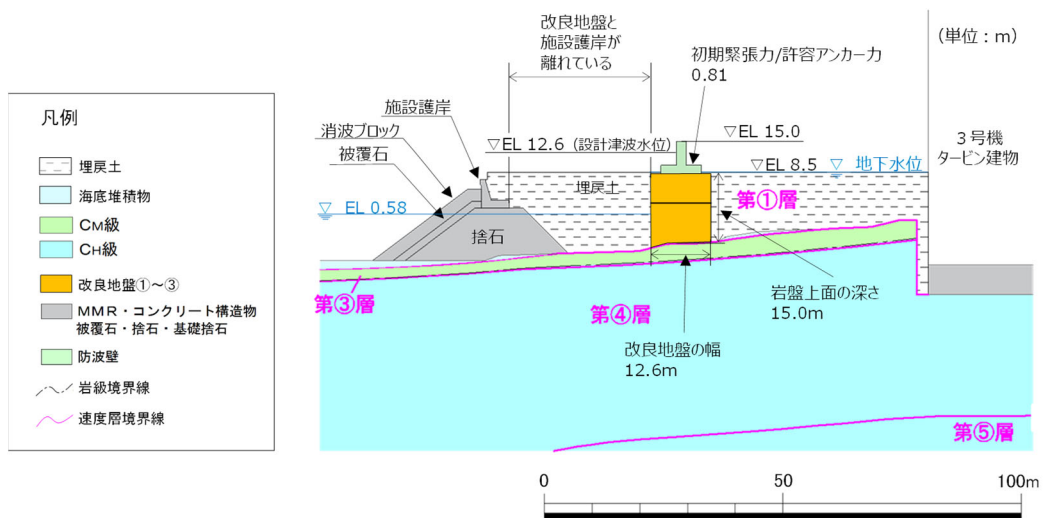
防波壁（逆 T 擁壁）の横断面図（④-④断面）
